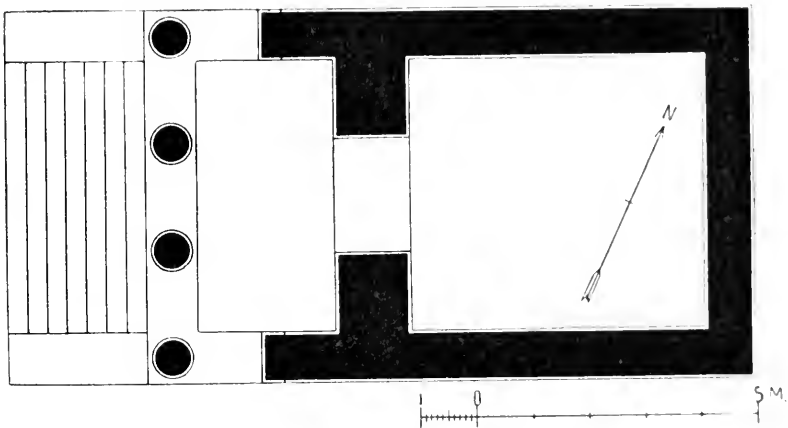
Ergänzier Grundriss des Tempels.
